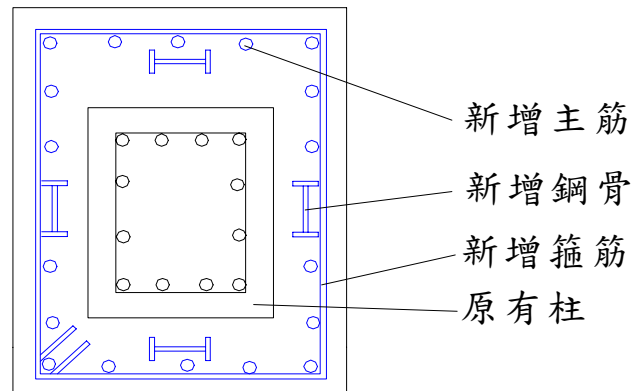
以鋼骨鋼筋混凝土擴大柱斷面
